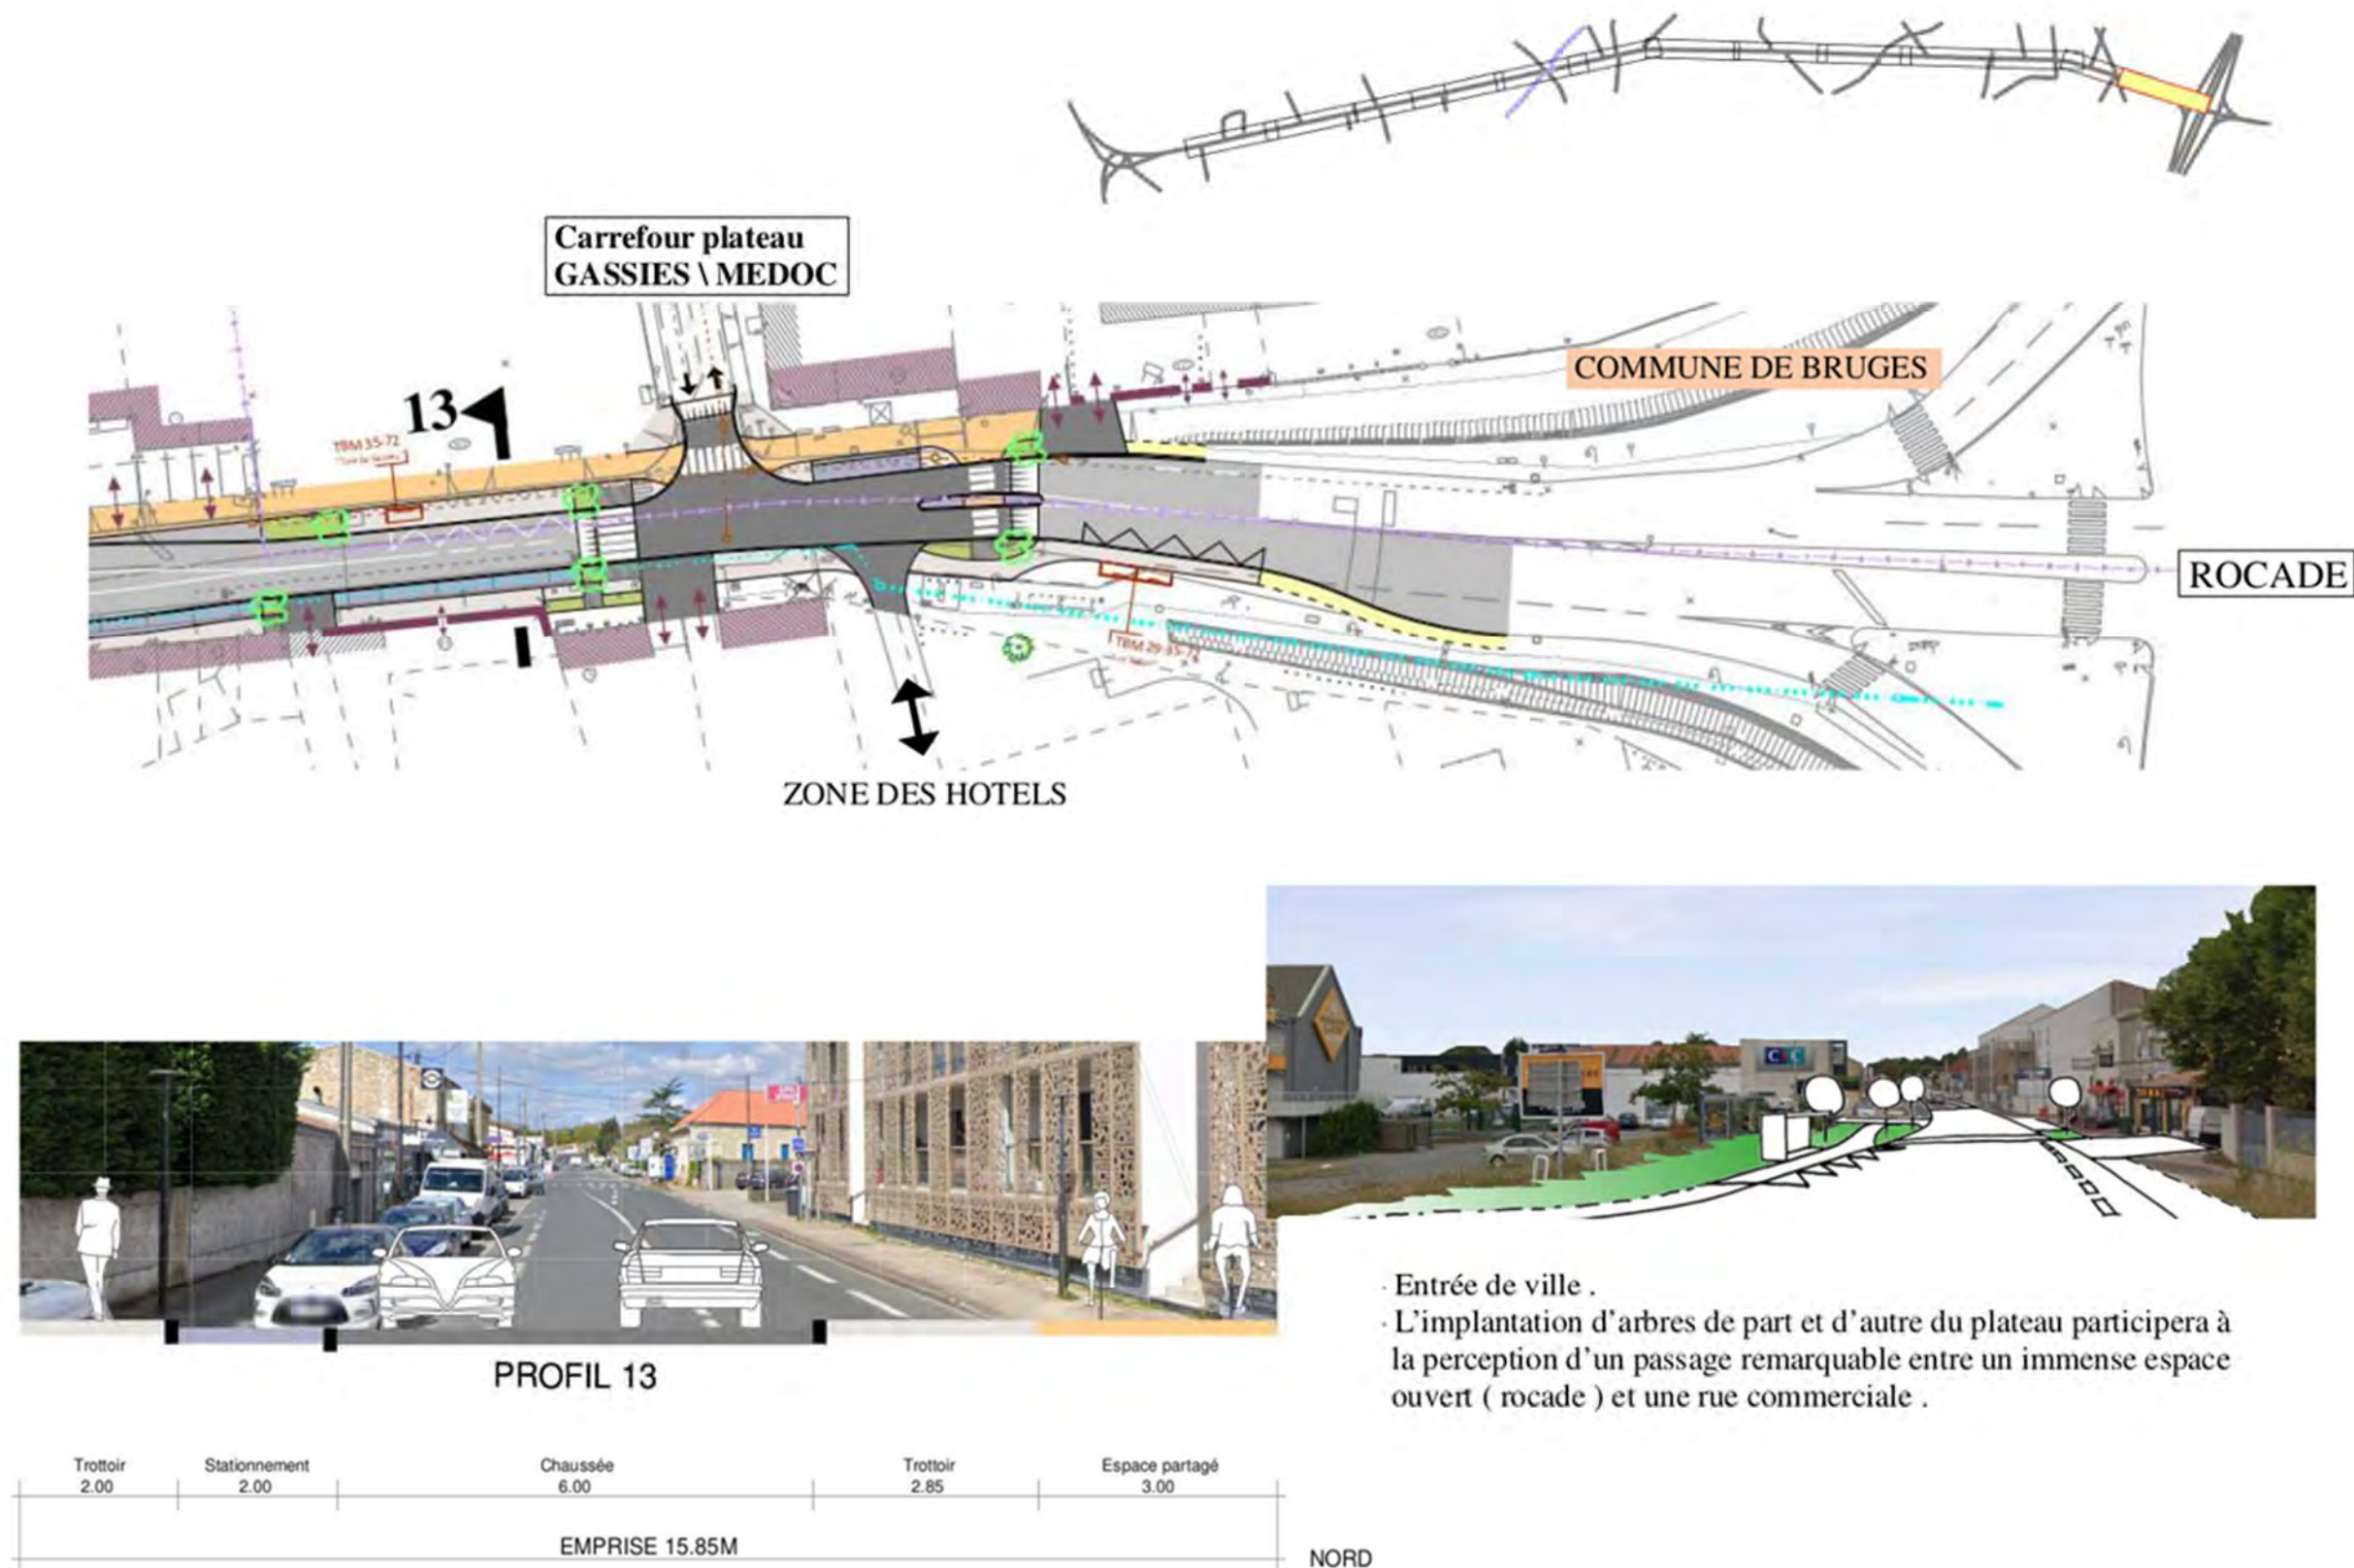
Plan général des travaux – séquence 2 - planche 8 (Source : Etudes préliminaires-Bordeaux Métropole)
